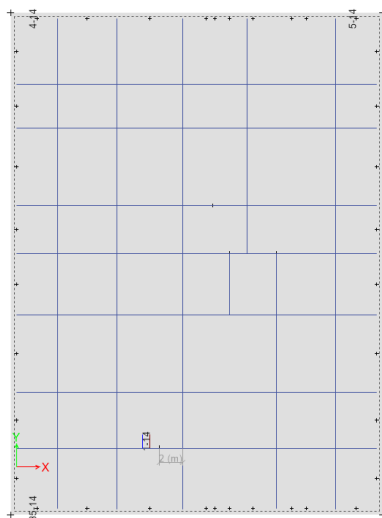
Ferrailage du radier sens x - face TOP RPA2024.
